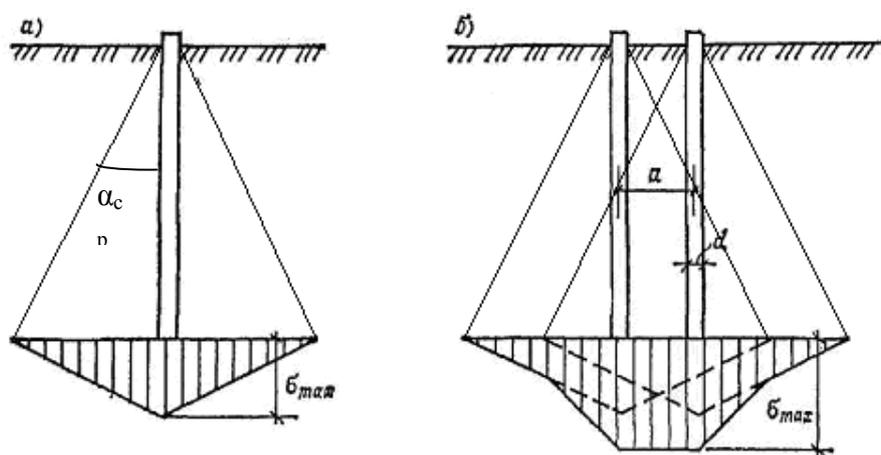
Эпюры давлений в плоскости, проходящей через нижние концы свай
